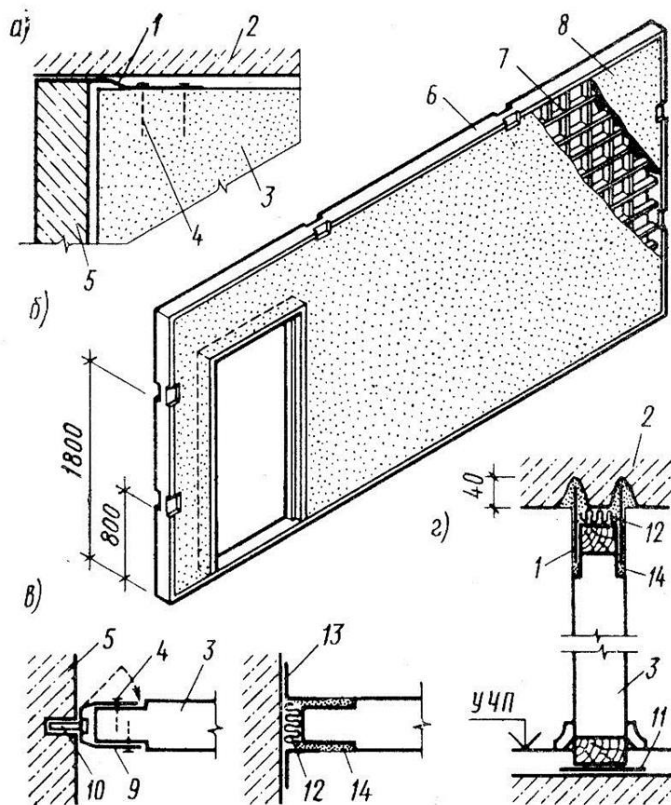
Крупнопанельные гипсобетонные перегородки:
